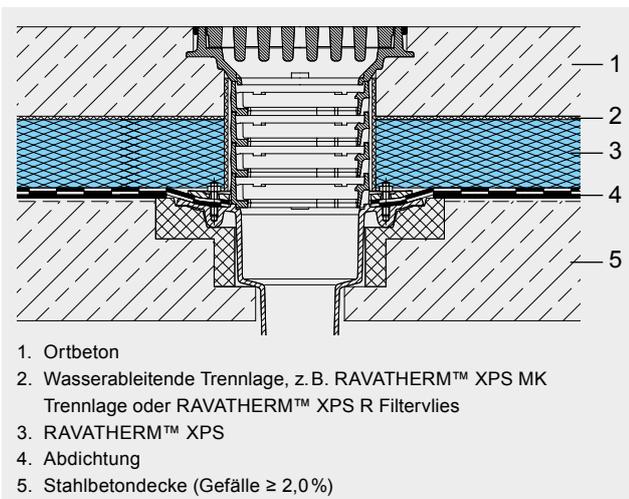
Aufbaubeispiel Parkdeck mit Ortbetonplatte
